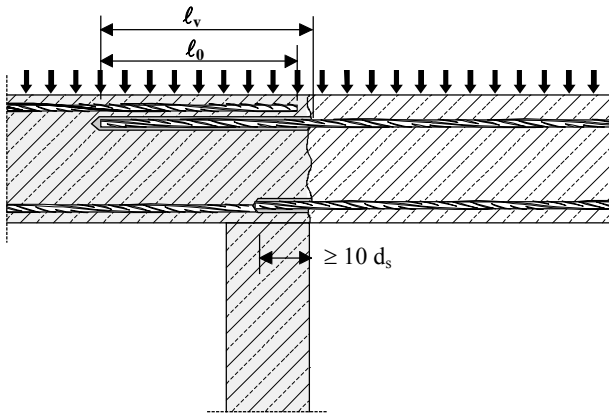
Recouvrement d'armatures pour la liaison de dalles et poutres
